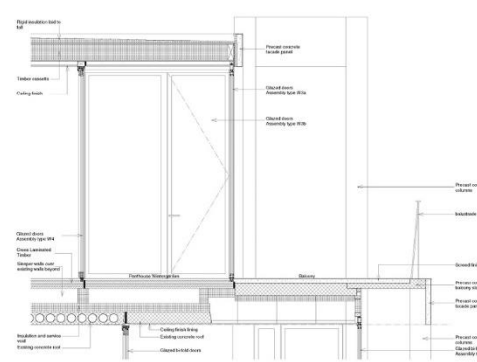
Sección constructiva - Nuevas viviendas azotea
